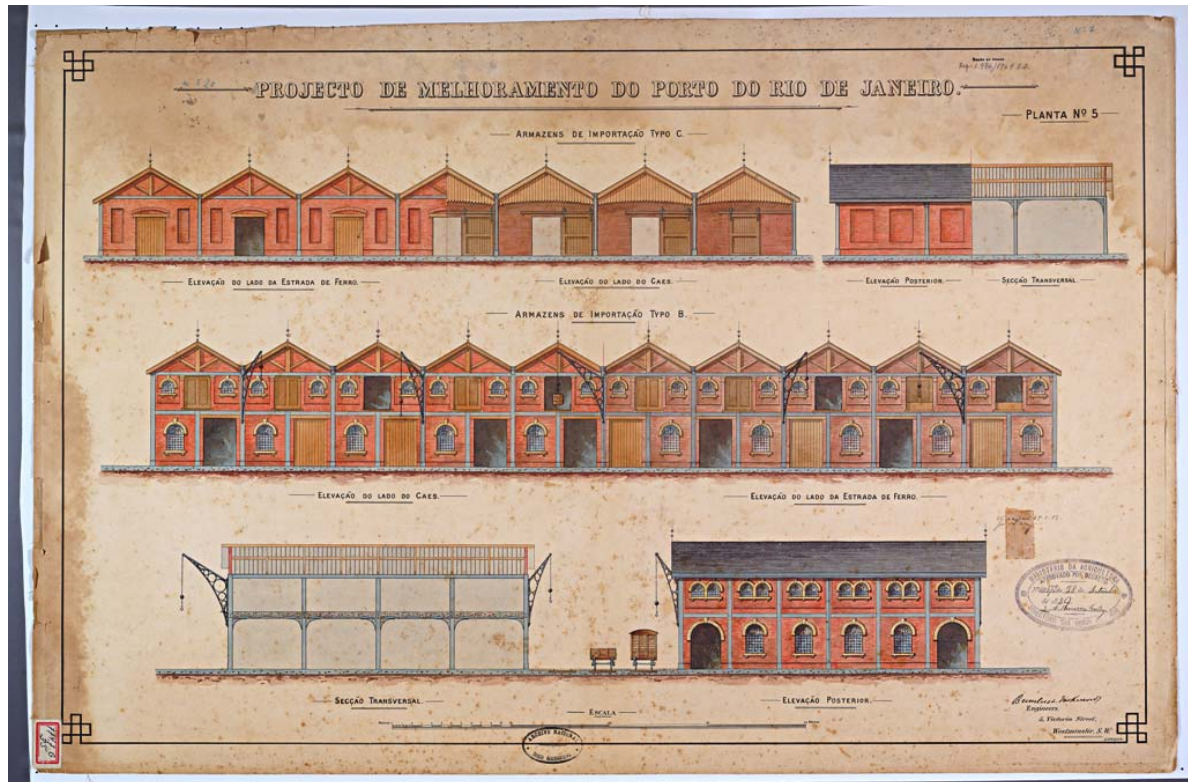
Porto do Rio de Janeiro – Planta Nº. 5
